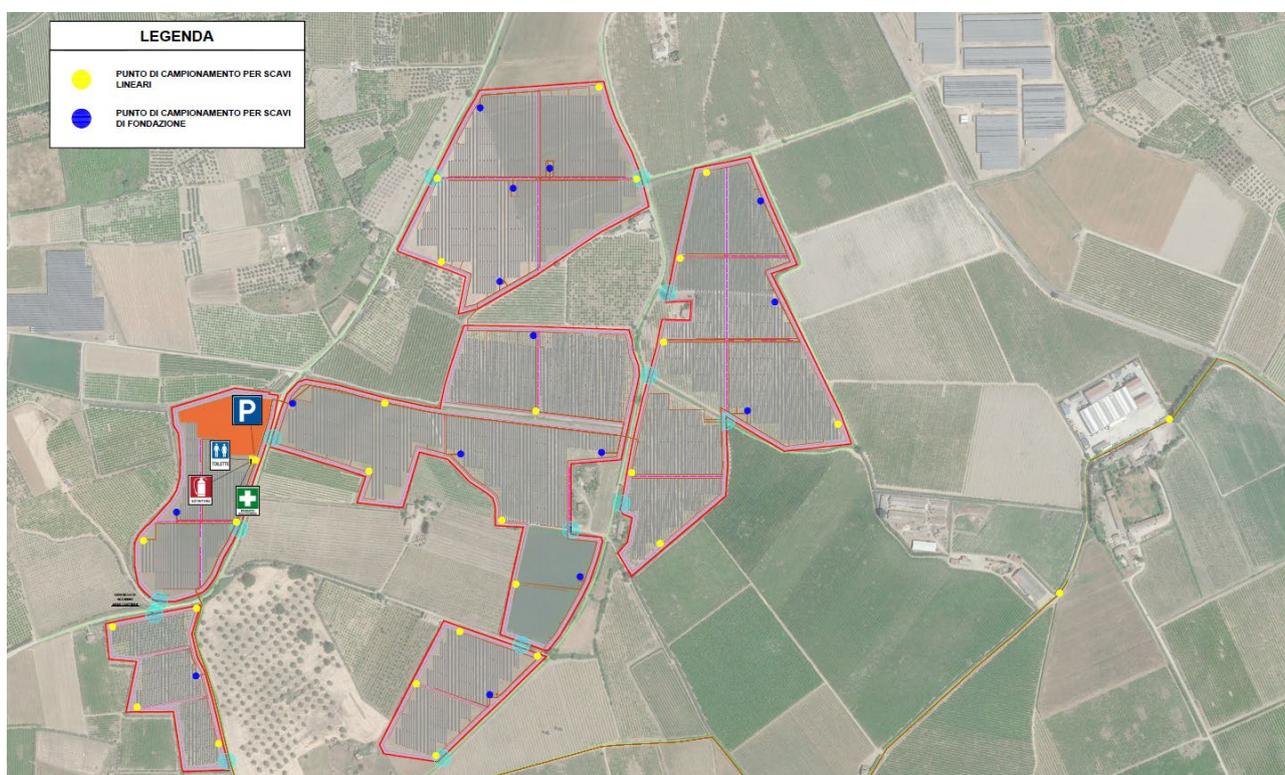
Layout impianto con piano di campionamento – Impianto aree B, C, D, E
